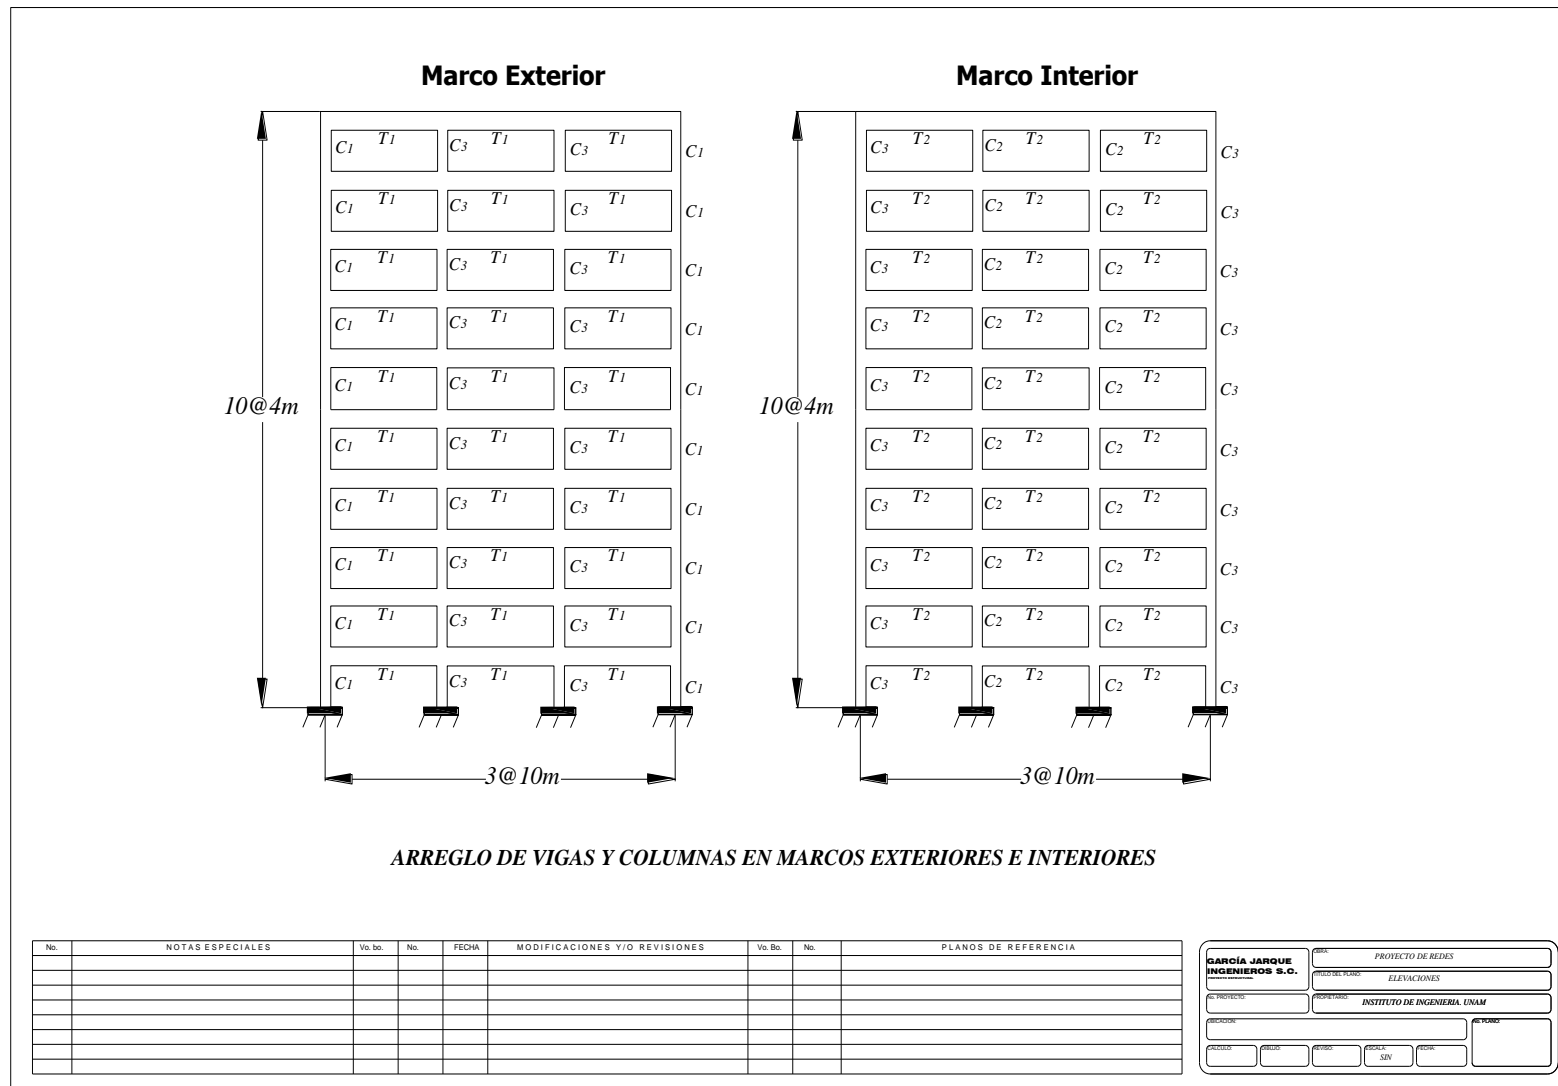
Detalles estructurales del edificio de 10 niveles diseñado con el RCDF-04
